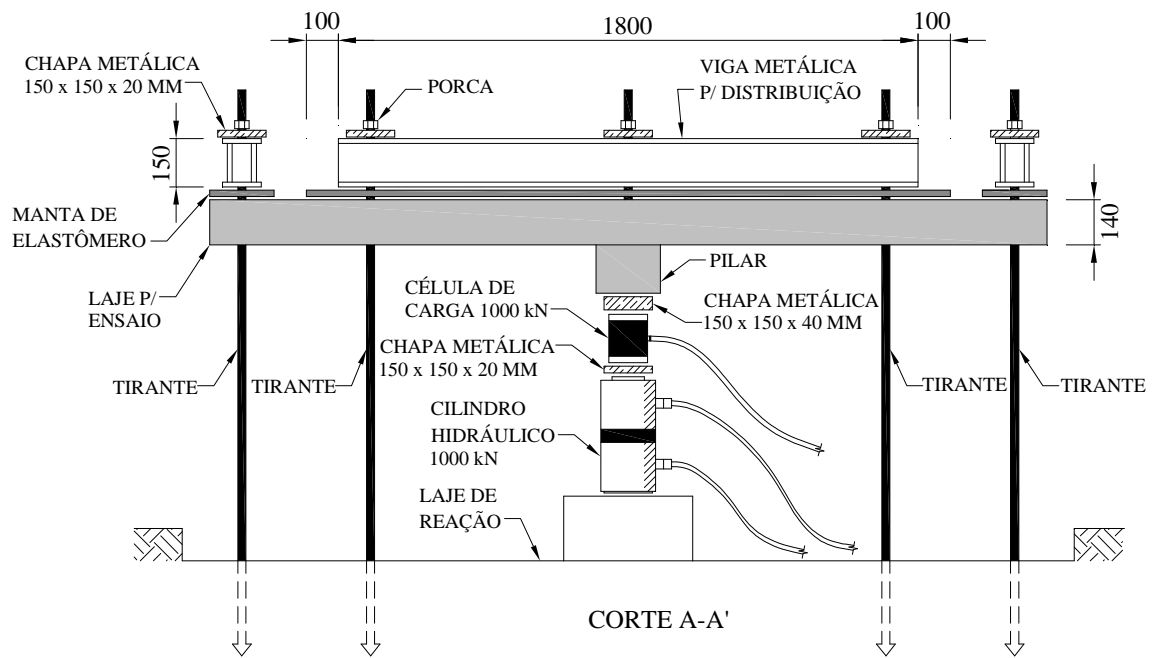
Esquema usado para o ensaio das lajes corte A-A'
